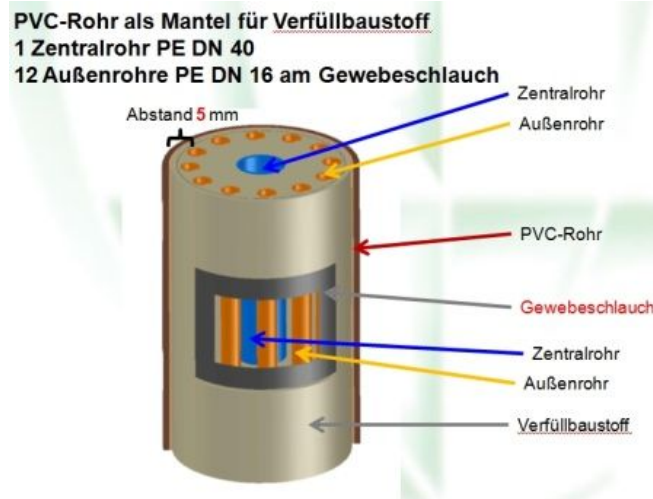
Eingebaute Probe mit Gewebeschlauch und Ringrohren mit geringem Wandabstand
